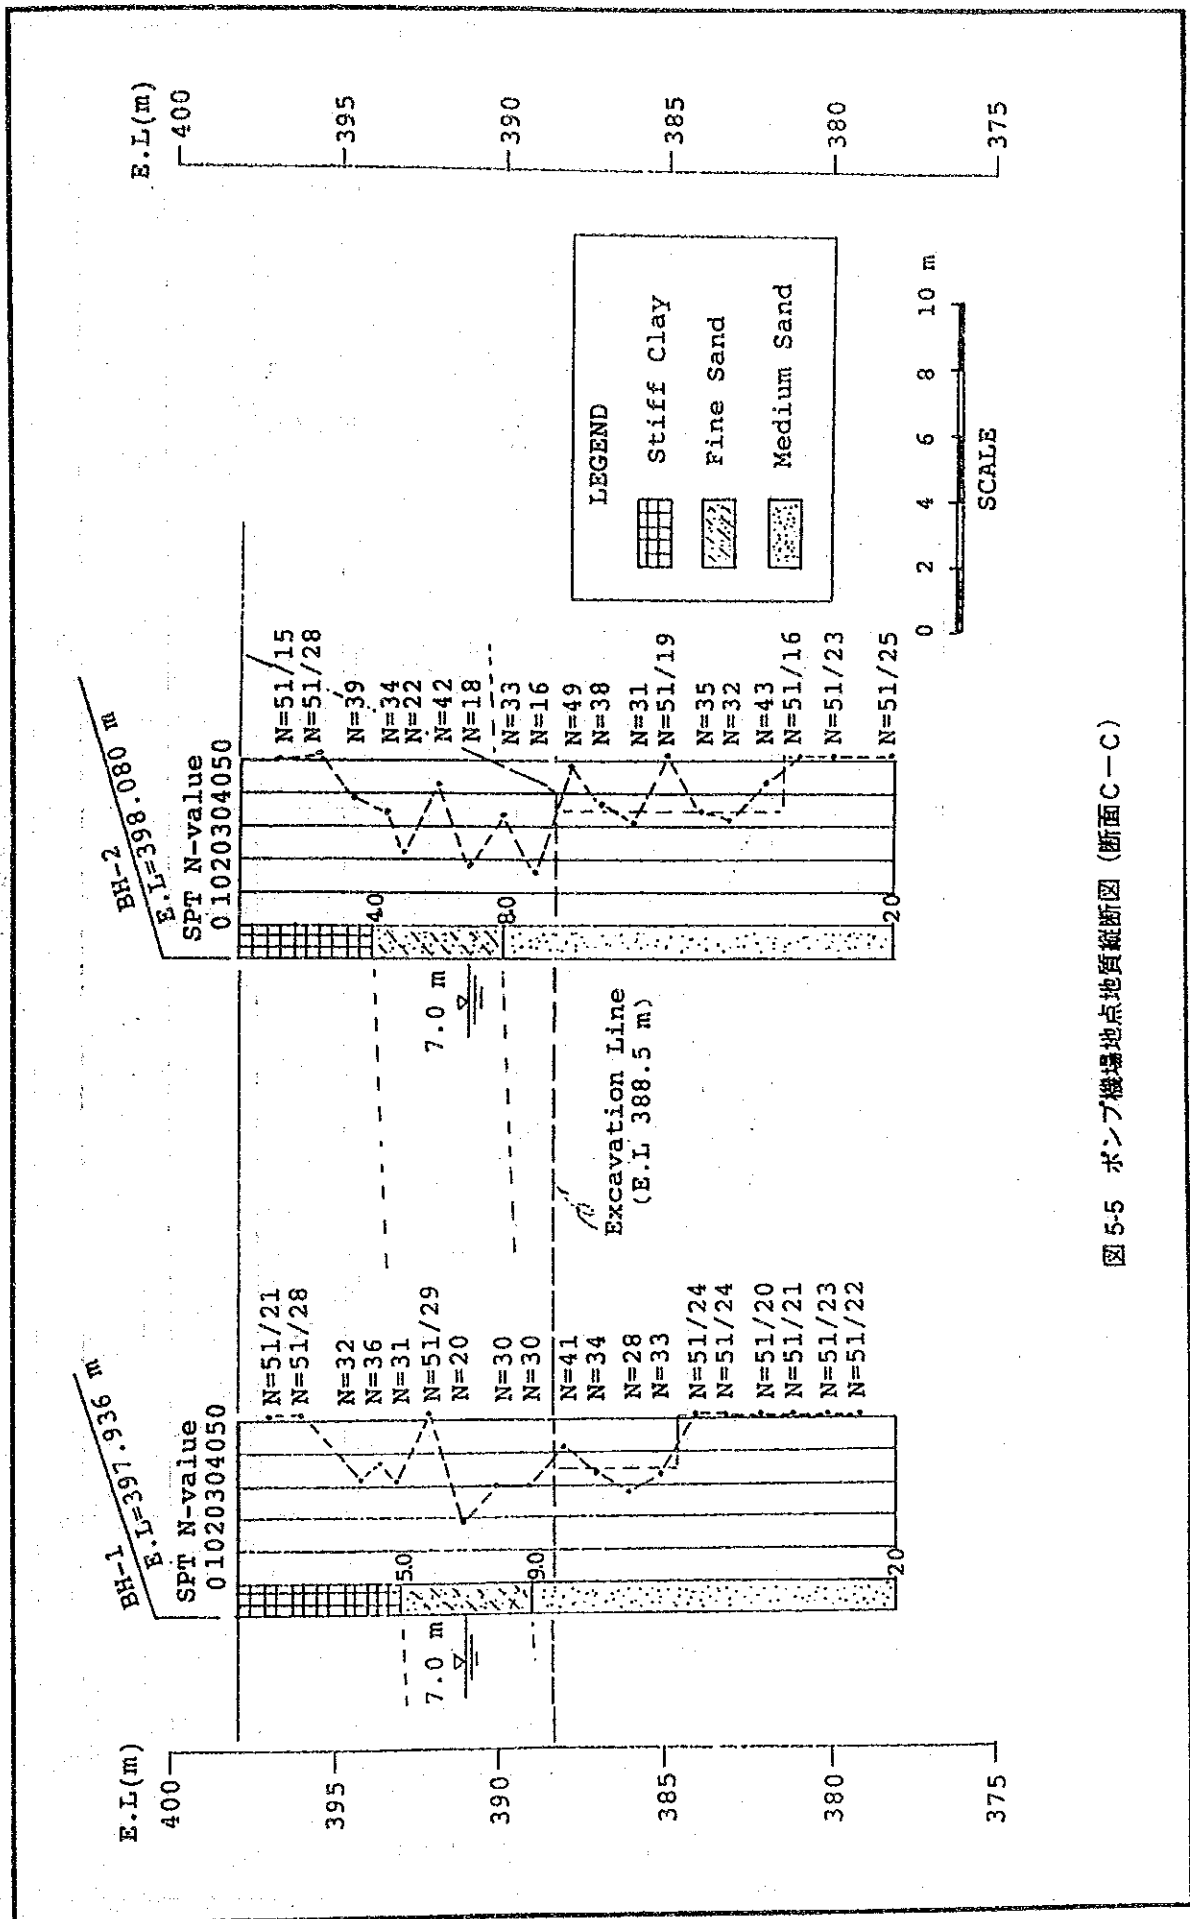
ポンプ機場地点地質縦断面図 (断面 C-C)
